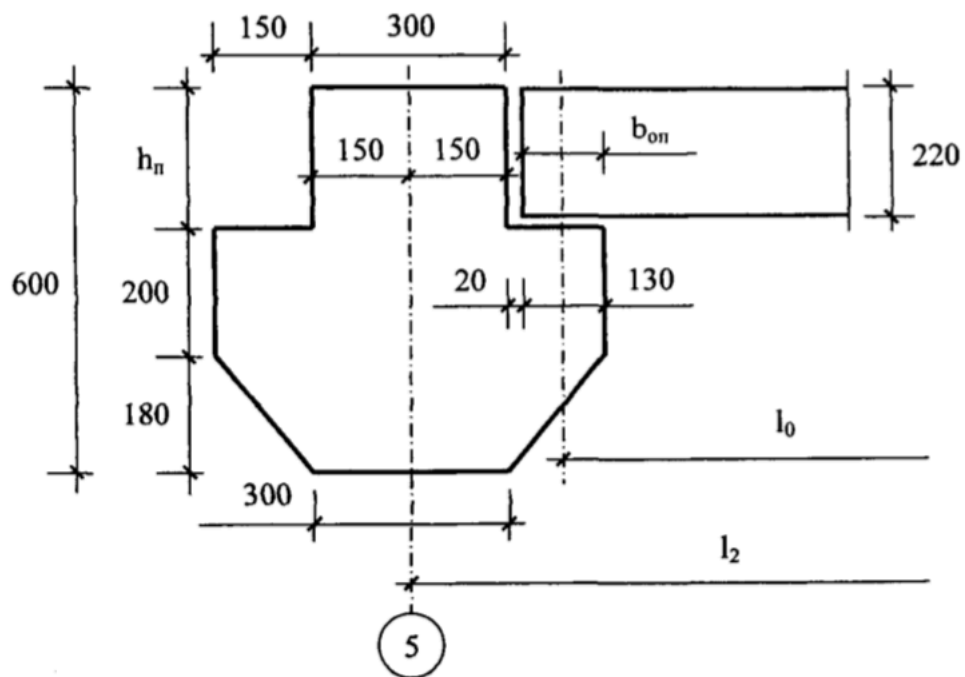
Схема узла опирания панели на полку ригеля крестового сечения
